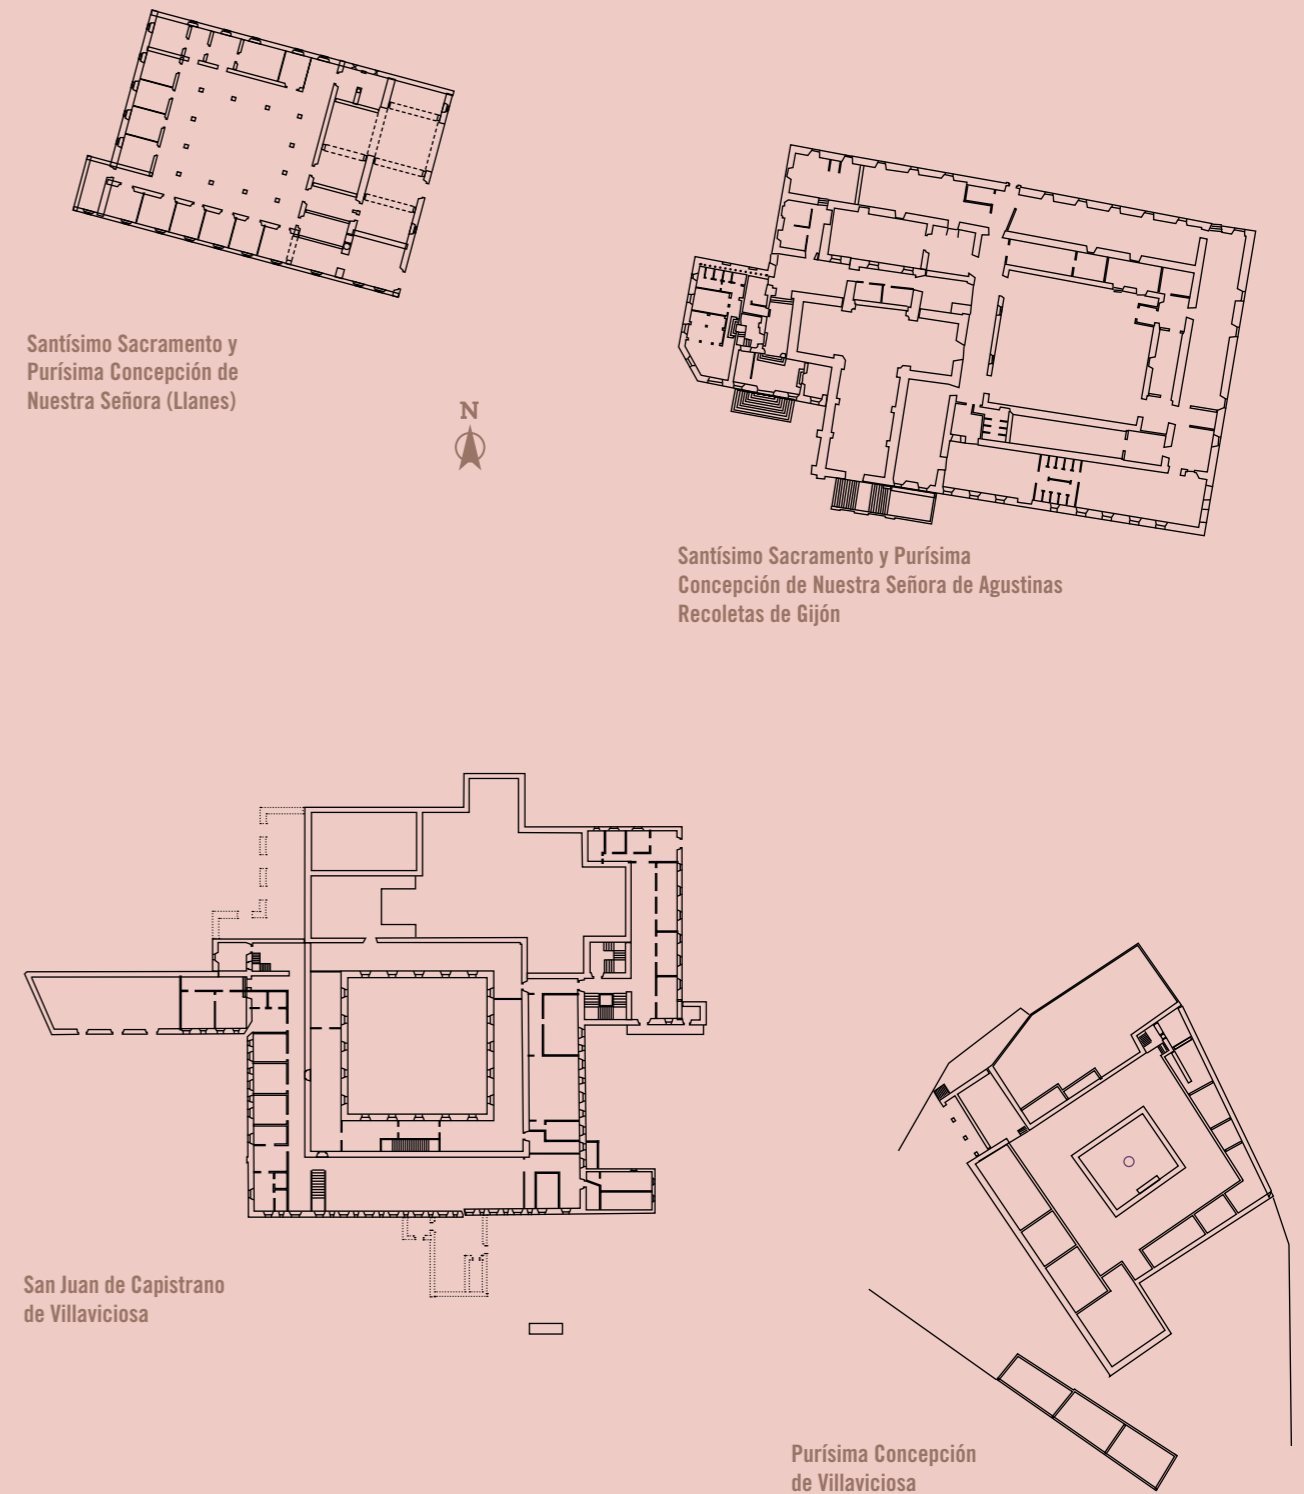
Lámina con la planta de los conventos de Llanes, Gijón y Capistrano y Concepción en Villaviciosa.
